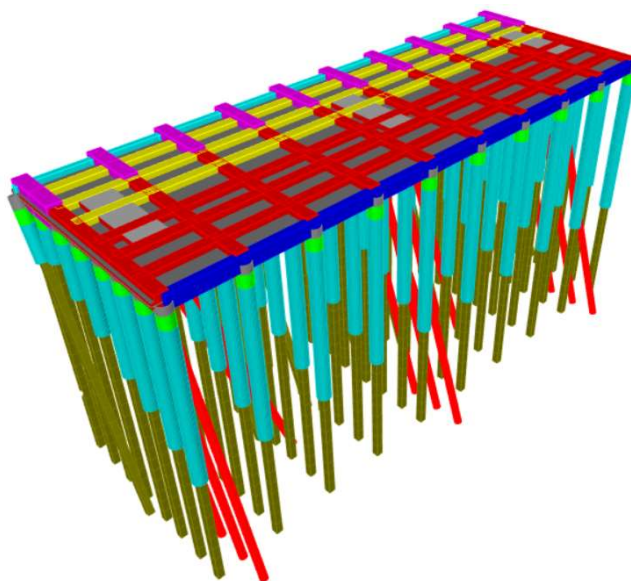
Modelo estructural del segmento de muelle N3 - Vista 3D
